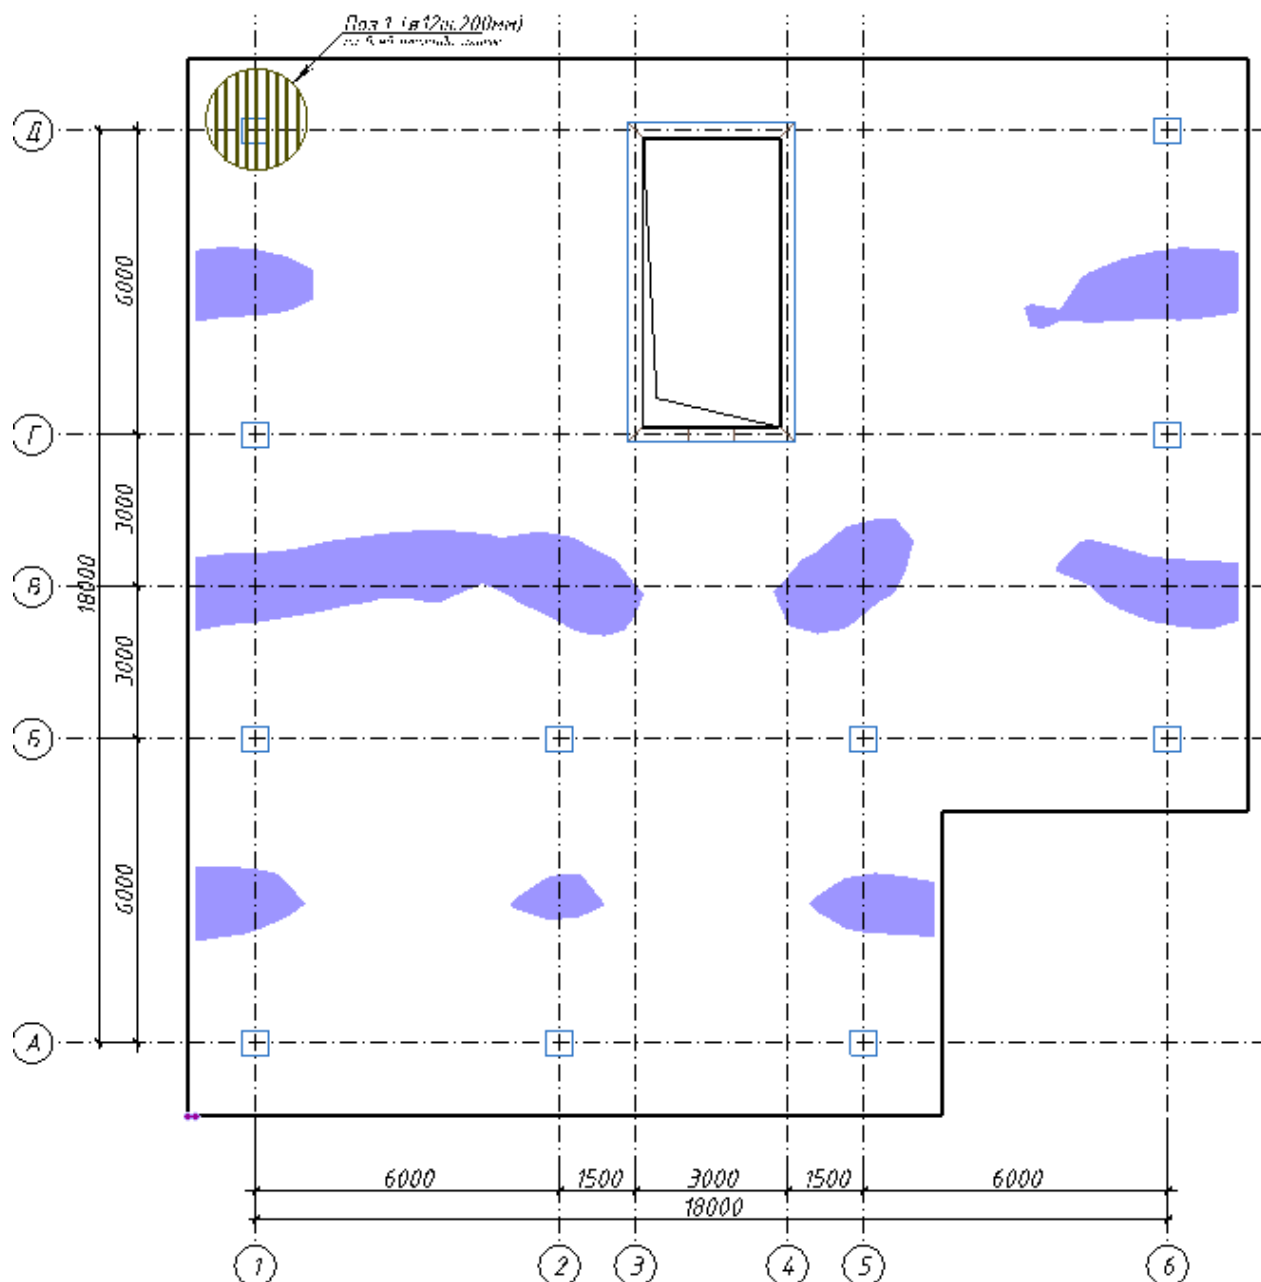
Изополя площадей армирования у нижней грани плиты вдоль оси Y.
